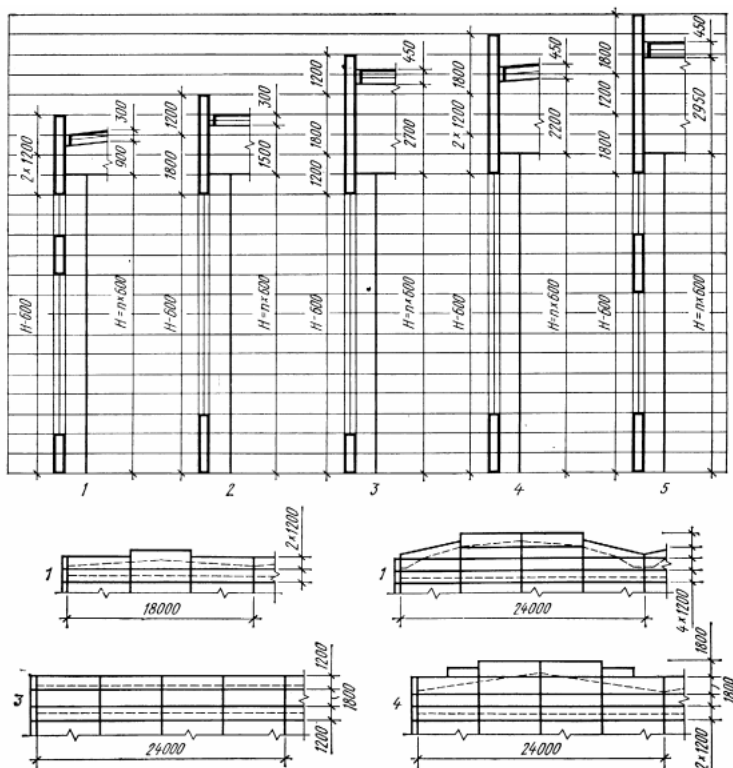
Схеми розкладки панелей у стінах одноповерхових будівель:
